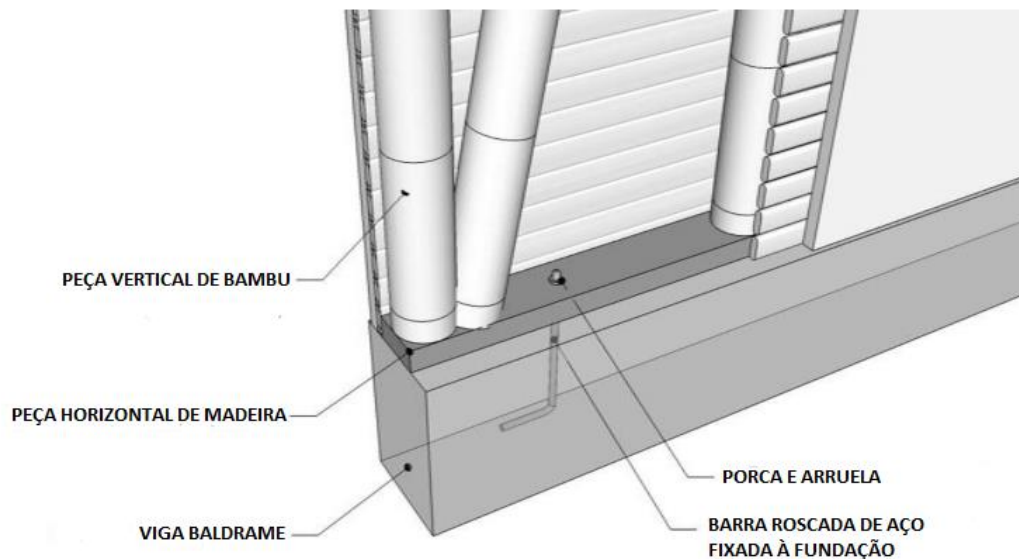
Fixação parede estrutural de bambu e viga da fundação. Fonte: Norma peruana NTE E.100 (2012) adaptada.
